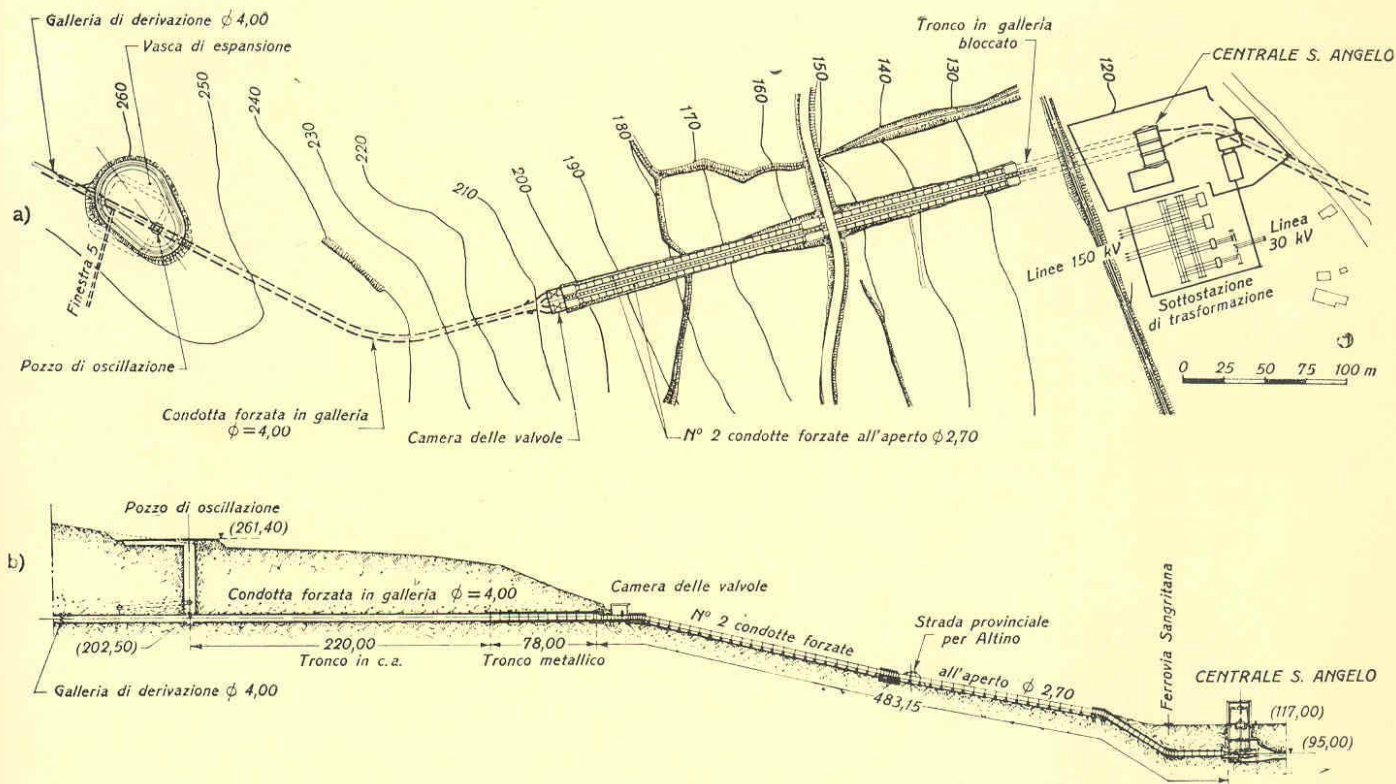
Pozzo piezometrico e condotte forzate — a) Planimetria - b) Profilo longitudinale.
